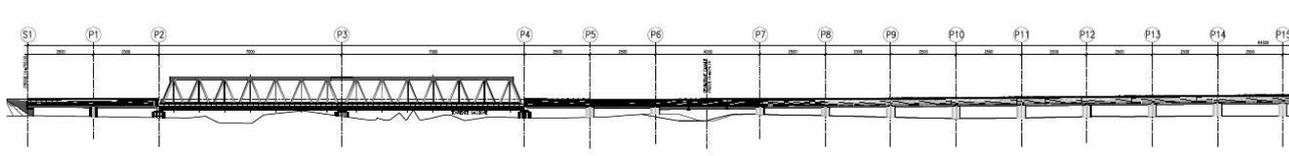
Viadotto sul torrente Saccione: stralcio del prospetto
